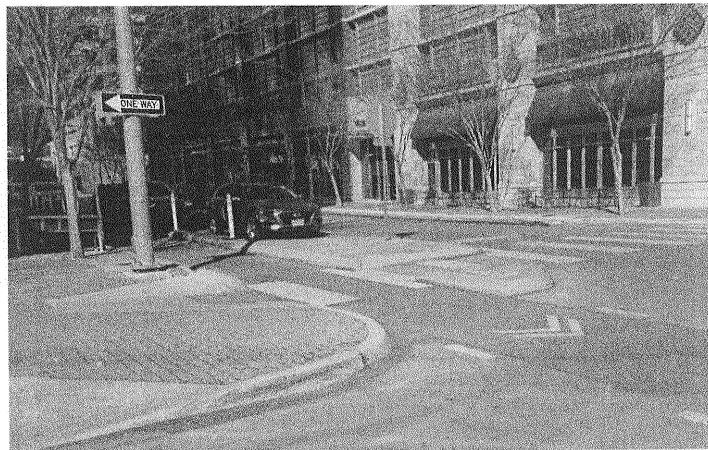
Uso de Orejas de banqueta con protección ciclista
